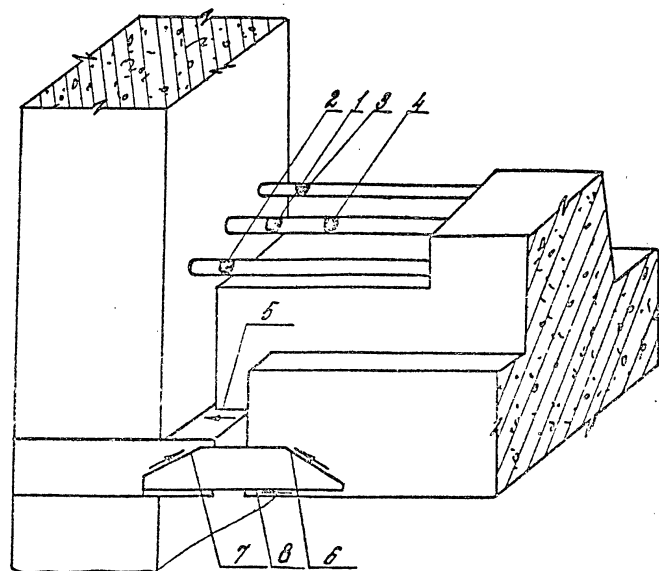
Порядок выполнения сварных соединений в узле крепления ригеля к плочине.
